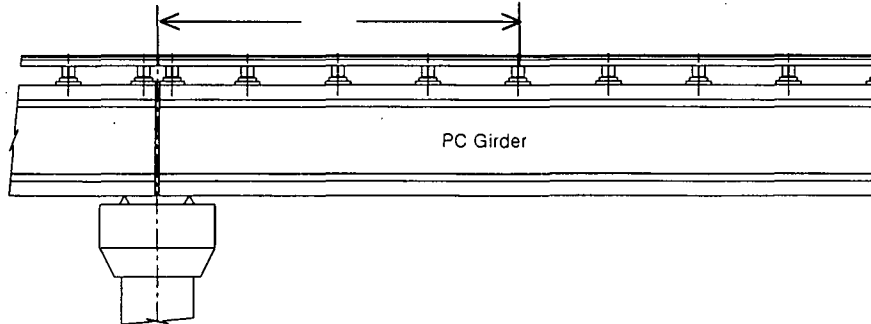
직선궤도 길이방향의 상부궤도 설치예 (PC Girder 구간)
